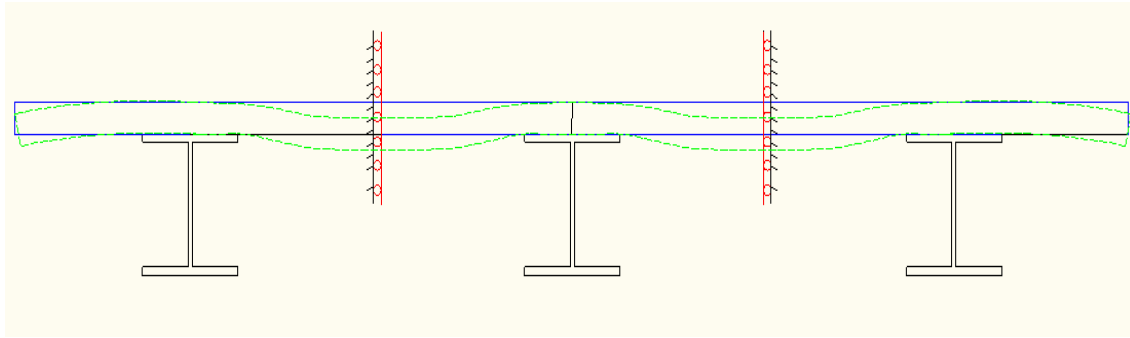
Deformada transversal de uma viga mista com 3 vigas metálicas.
